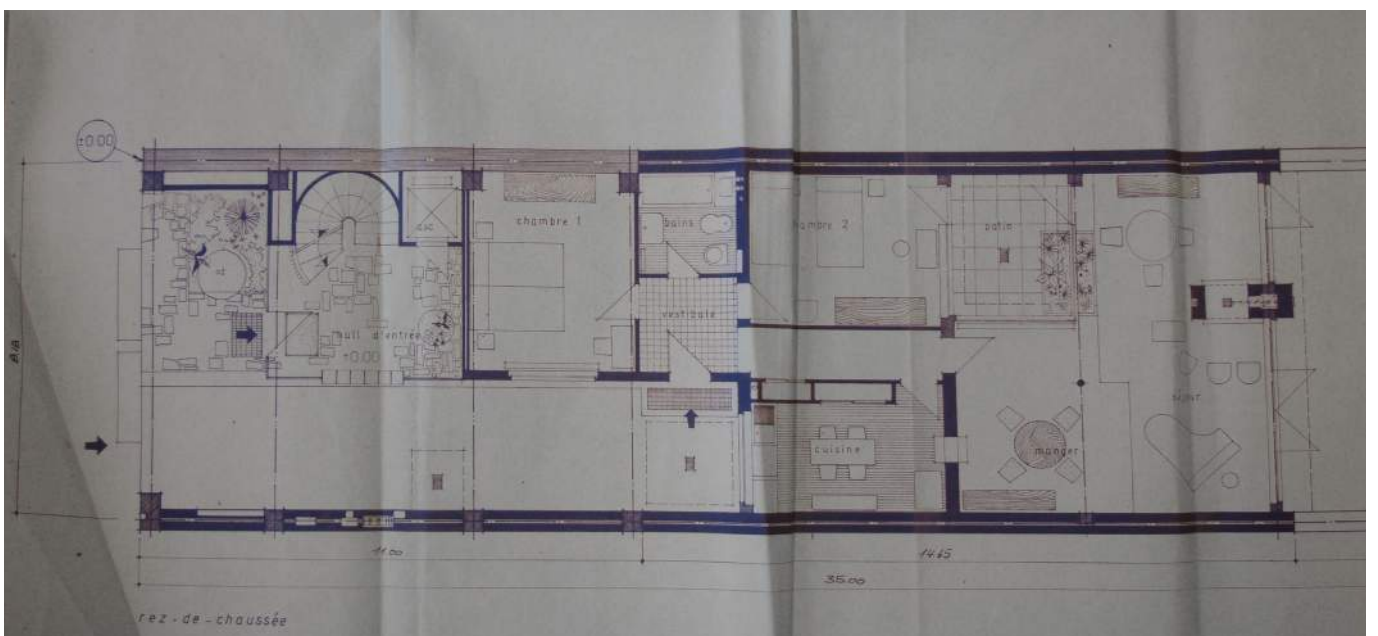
Grundriss, Erdgeschoß (1960)
